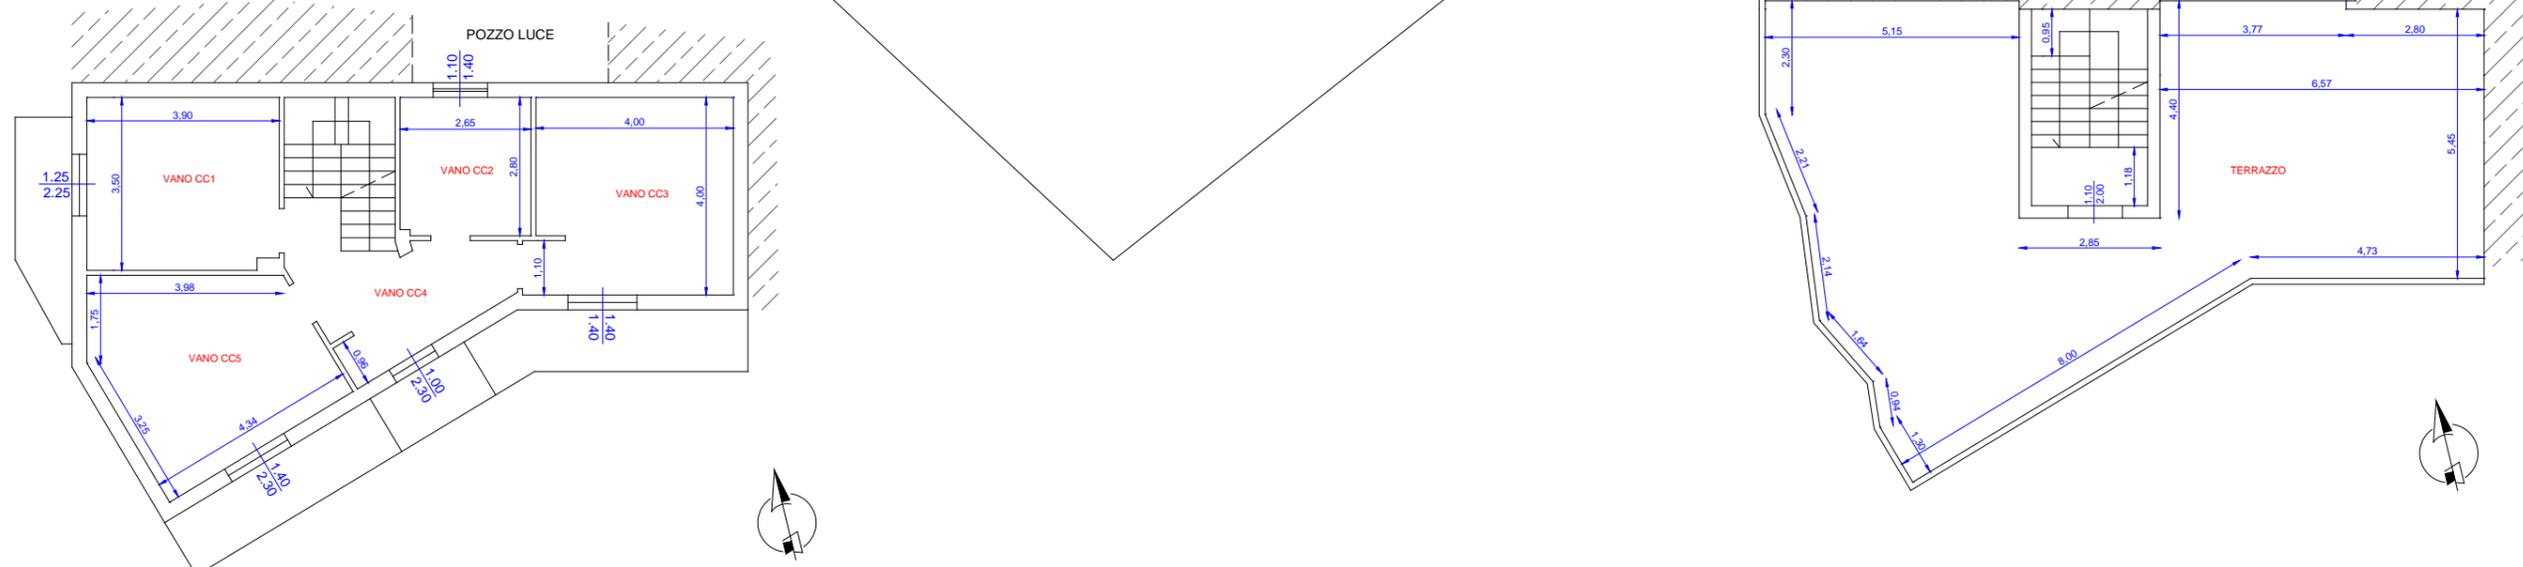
Planimetria da rilievo subalterno 1 – particella 1029 – foglio 6 – Caraffa di Catanzaro
